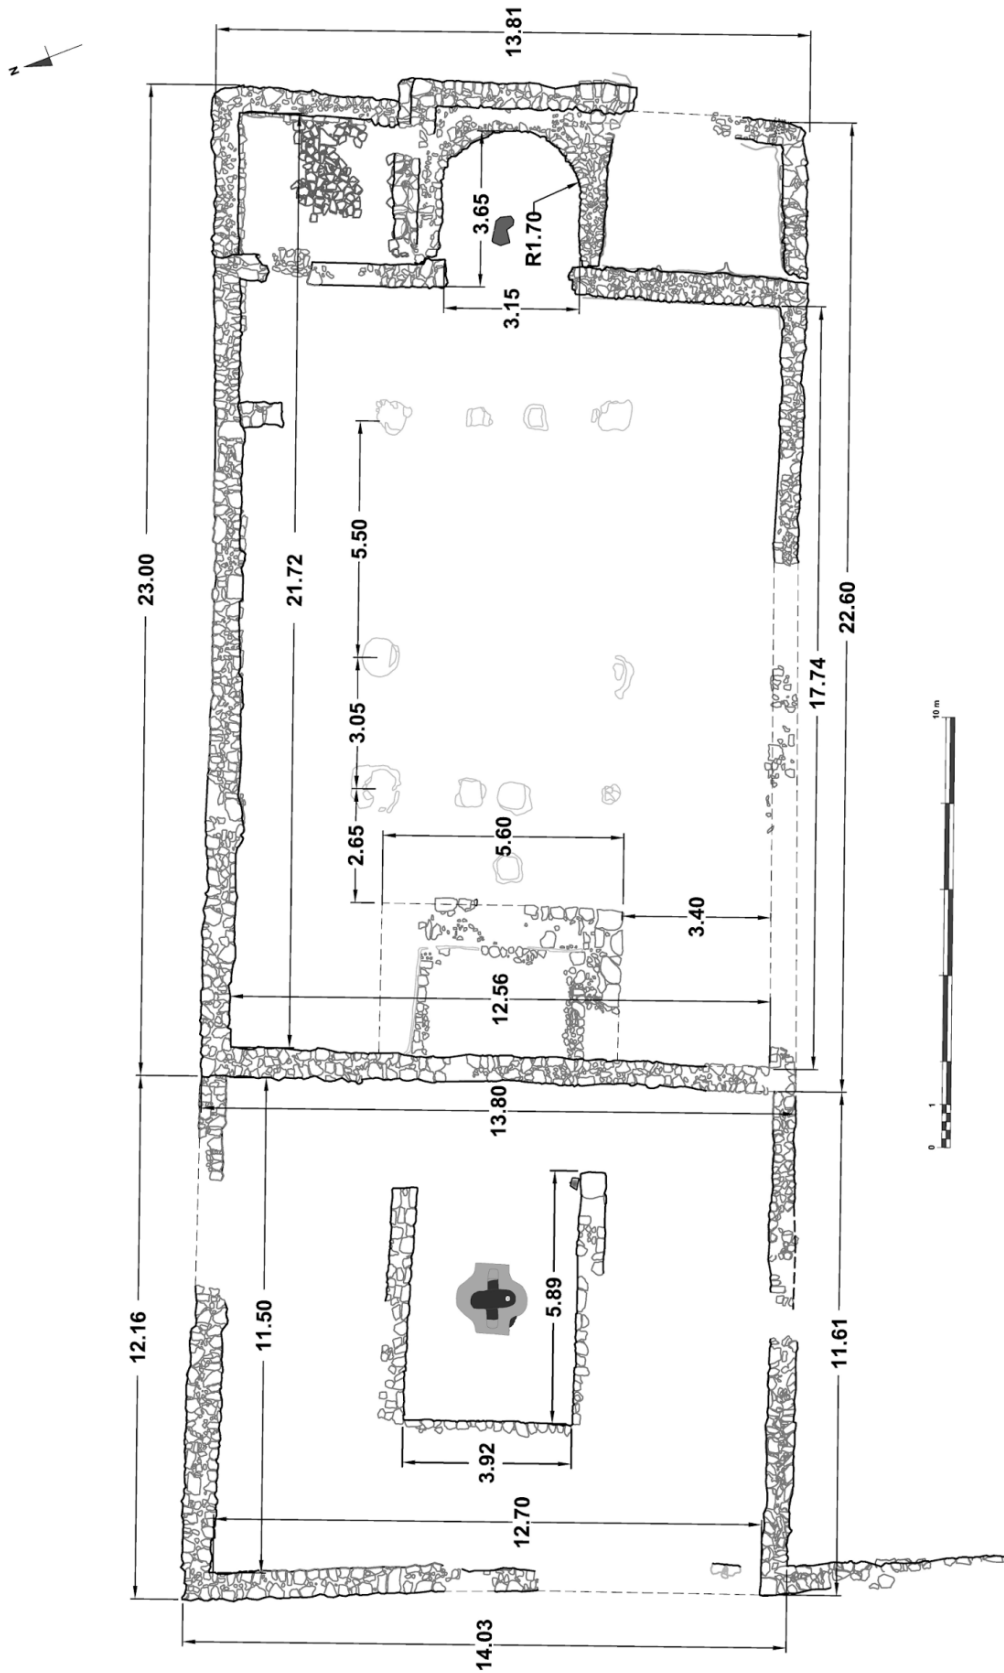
Planta con las principales dimensiones, en metros, del baptisterio y la basílica
